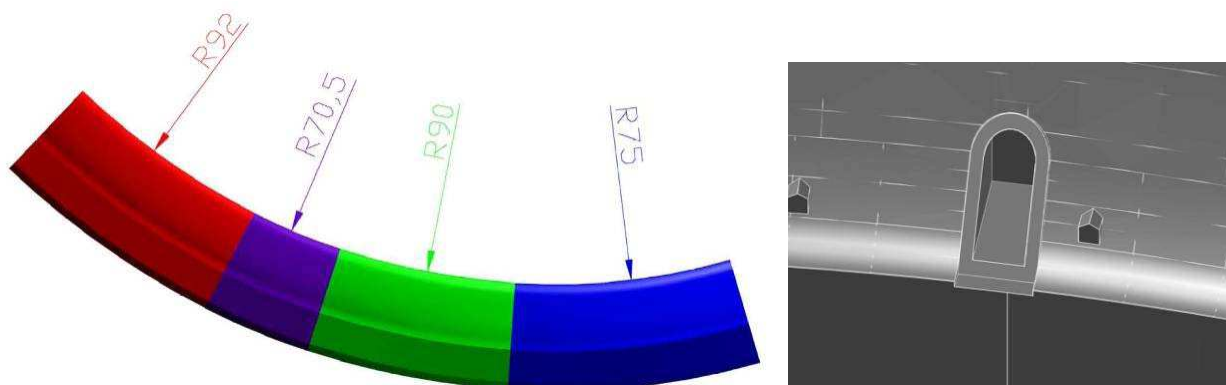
links: Konstruktion des Staumauergrundkörpers in AutoCAD®, rechts: Detailgetreue Modellierung der Einbauten im Staumauerkörper
